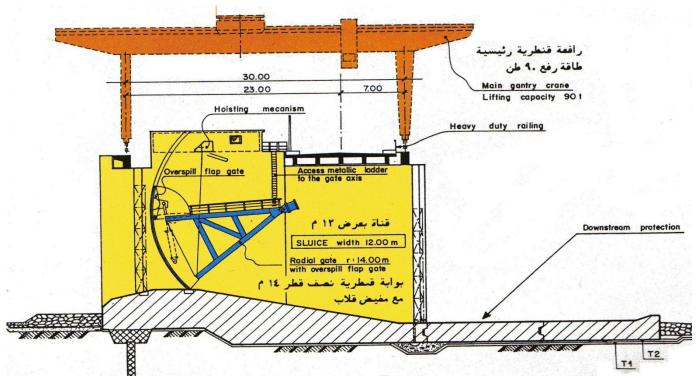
قطاع طولي في قناطر نجع حمادي الجديدة
